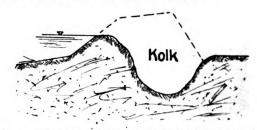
Querichnitt eines burch Deichbruch gerftorten Deiches mit babinterliegendem Kolt.
